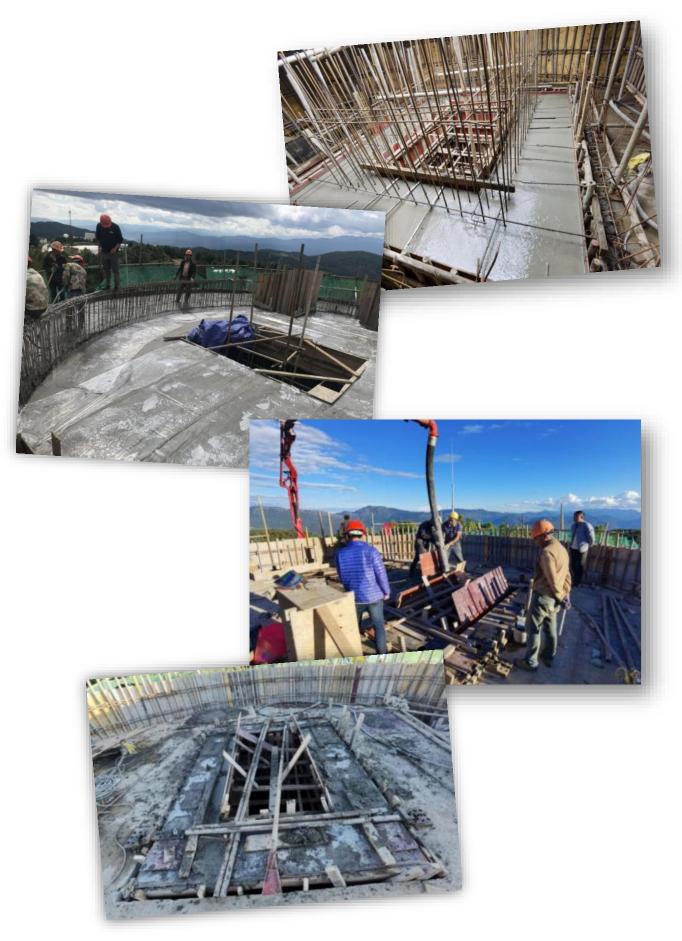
自上而下: 第二段基墩完成浇筑; 建筑物五层完成浇筑; 第三段基墩浇筑 From top to bottom: concreting the second section of the telescope base pier trough (completed); concreting the fifth floor of the telescope main building (completed); concreting the final section of the telescope base pier trough
